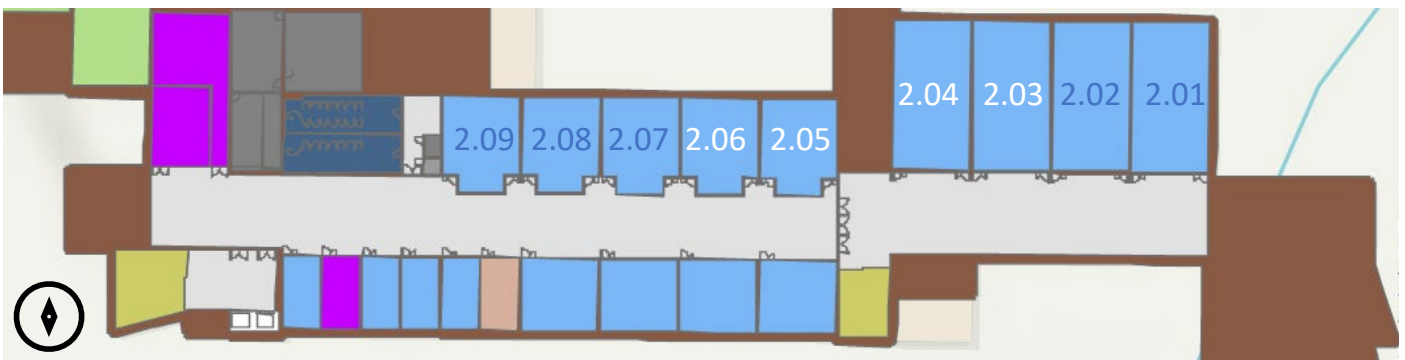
Detalle de la planta segunda del edificio Betancourt. Fuente: SIGEUZ
